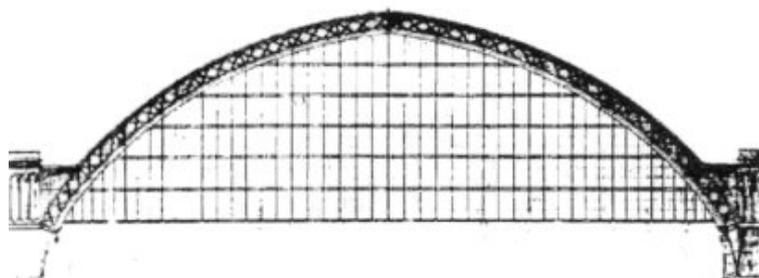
Estação St. Pancras, Londres. Corte Transversal.
